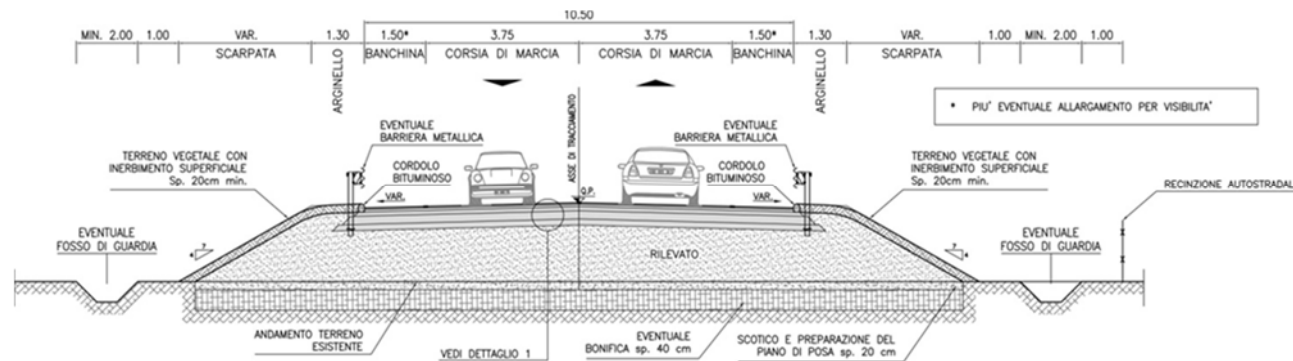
10 Sezione tipo – Rampa di svincolo bidirezionale
